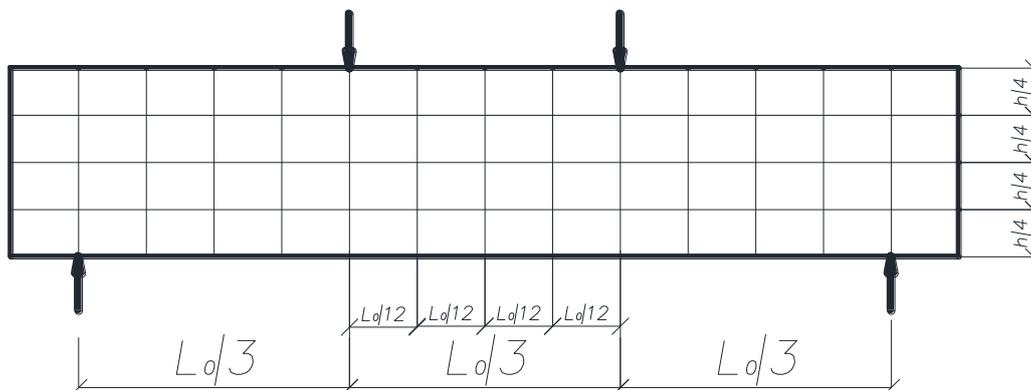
Схема (заготовка) карты трещин и характера разрушения
